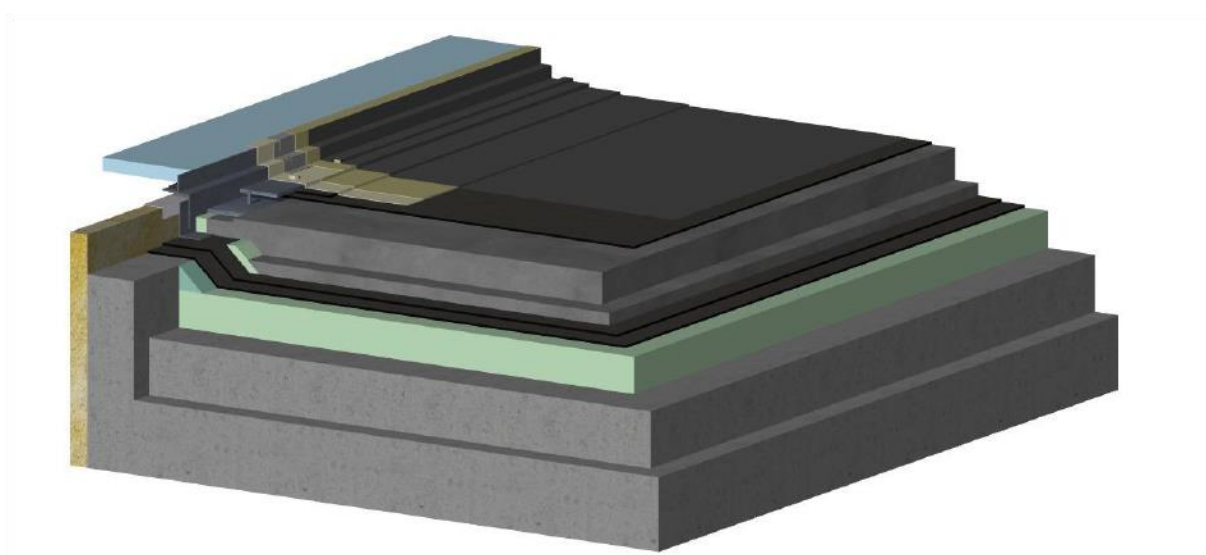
Provádění pochozí úpravy kolem světlíků
